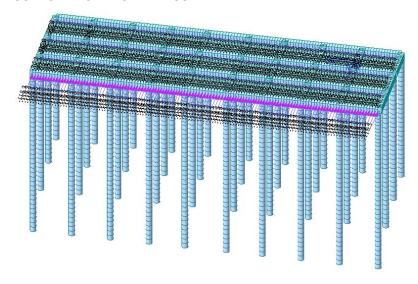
modellazione – condizione di carico: forza orizzontale sulle travi
